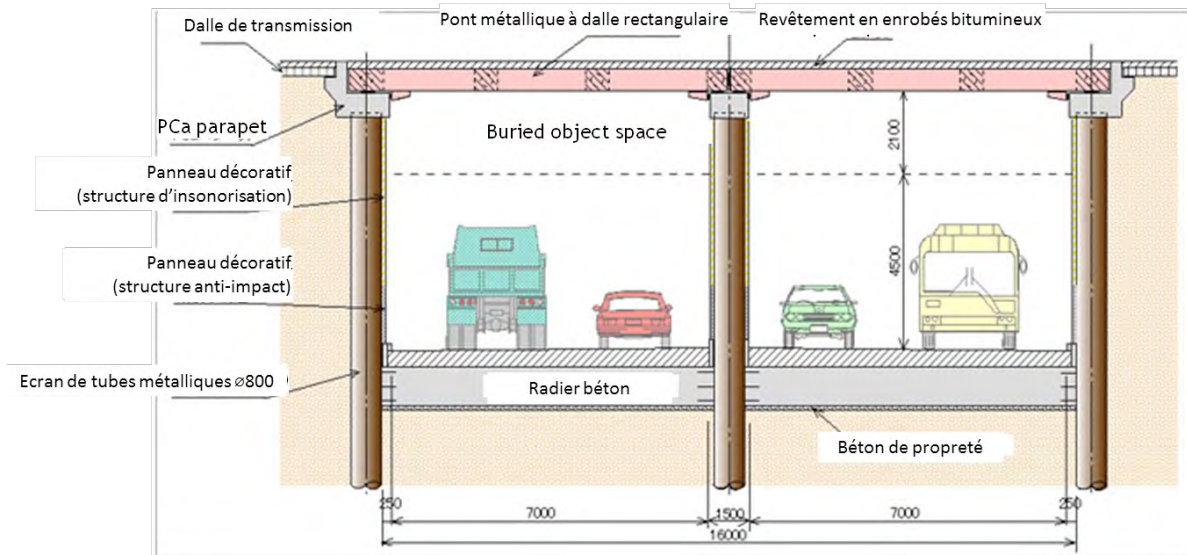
Exemple de construction de pont métallique en forme de H
